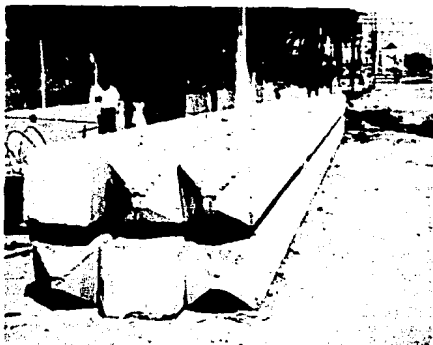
El calzado de los pilotes para su almacenamiento en obra, se llevó a cabo con pedazos de madera a la altura de los ganchos de izaje.
